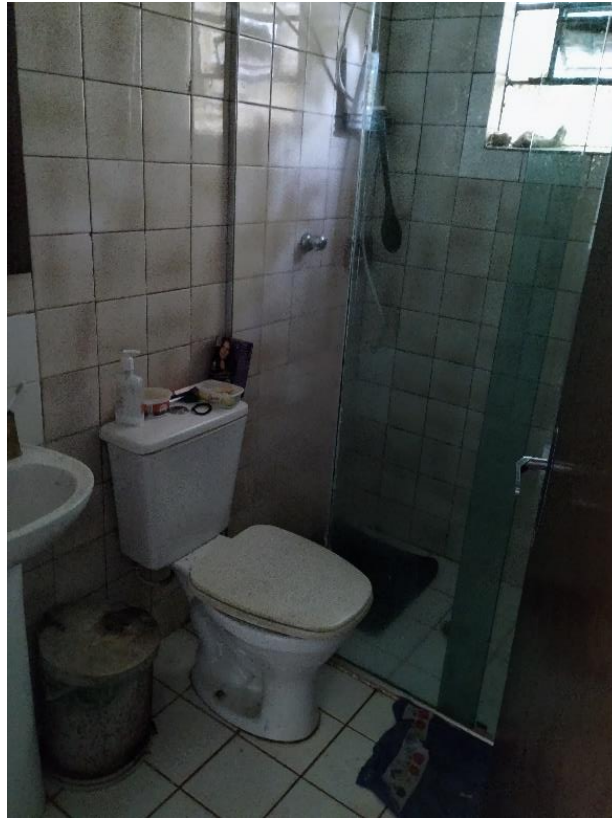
CASA CASEIRO, BANHEIRO
